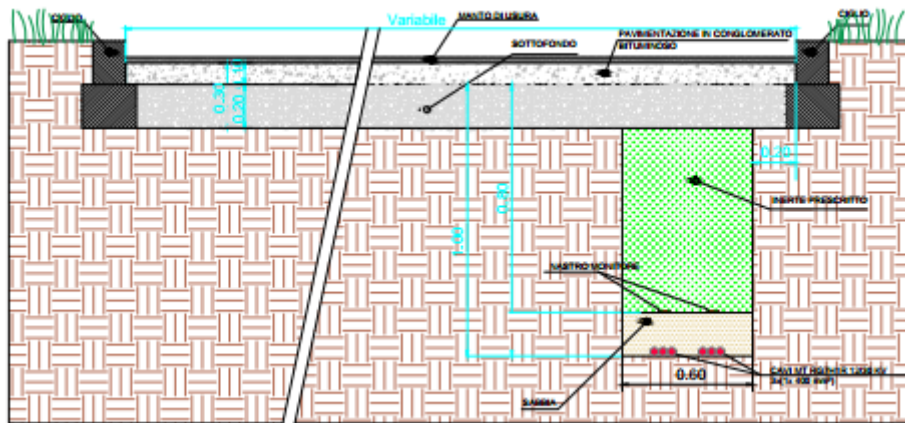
Sezione tipo attraversamento strada provinciale e comunale
